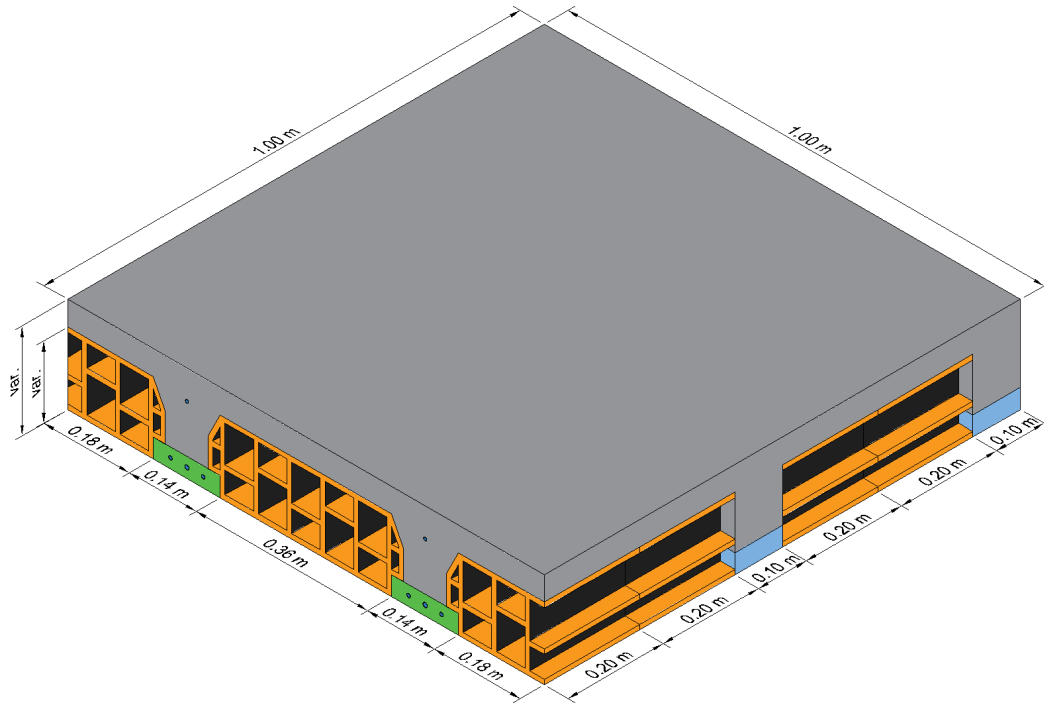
Losa Aligerada Bidireccional del Sistema Prefabricado Alitec.
